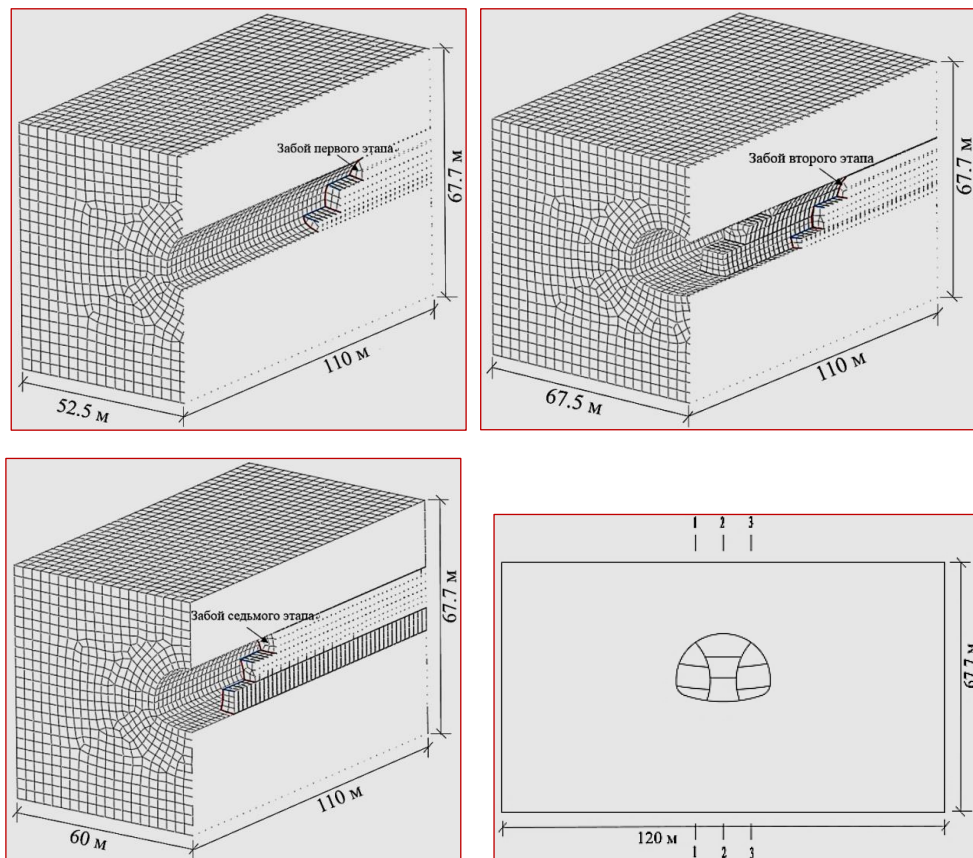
Этапы ведения проходческих работ при раскрытии выработки
